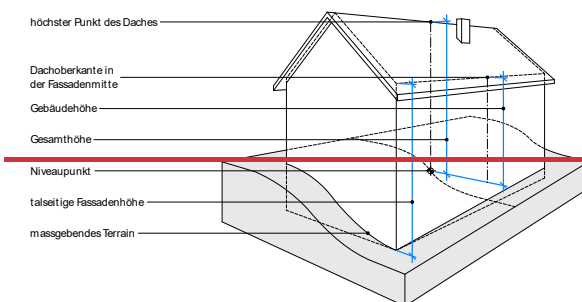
Talseitige Fassadenhöhe gemäss Art. 15 BauR
